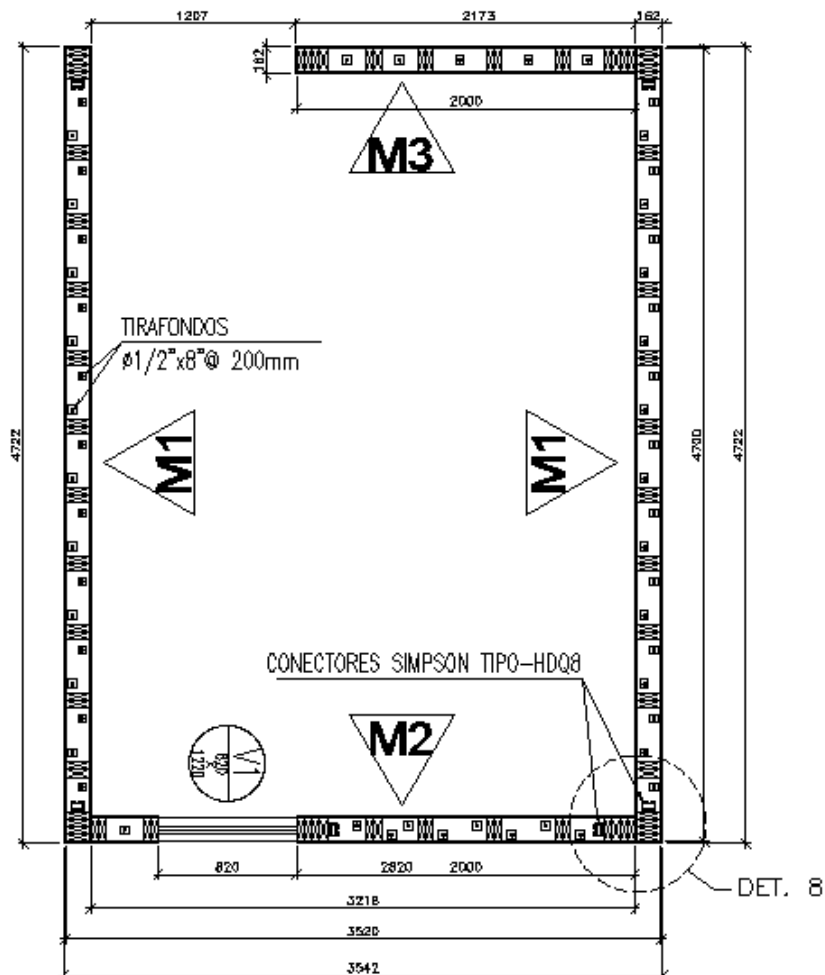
Planta arquitectónica de Módulo (unidades en milímetros).
